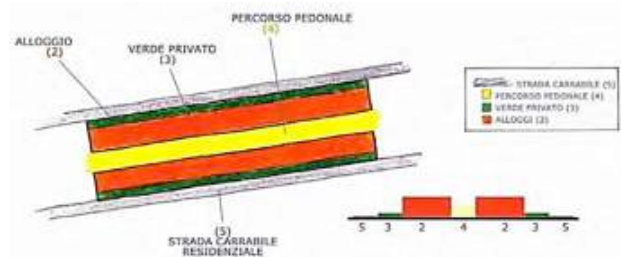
Schema di distribuzione planimetrica delle case a schiera.
